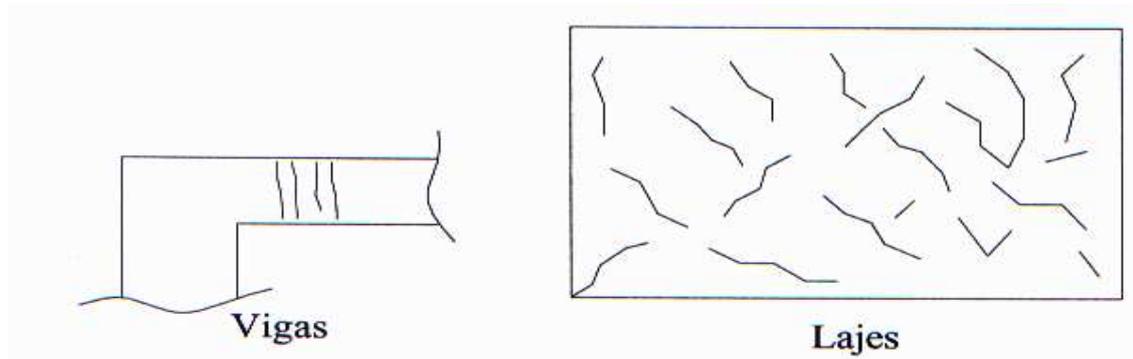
Configuração de fissuras por retração em vigas e lajes
